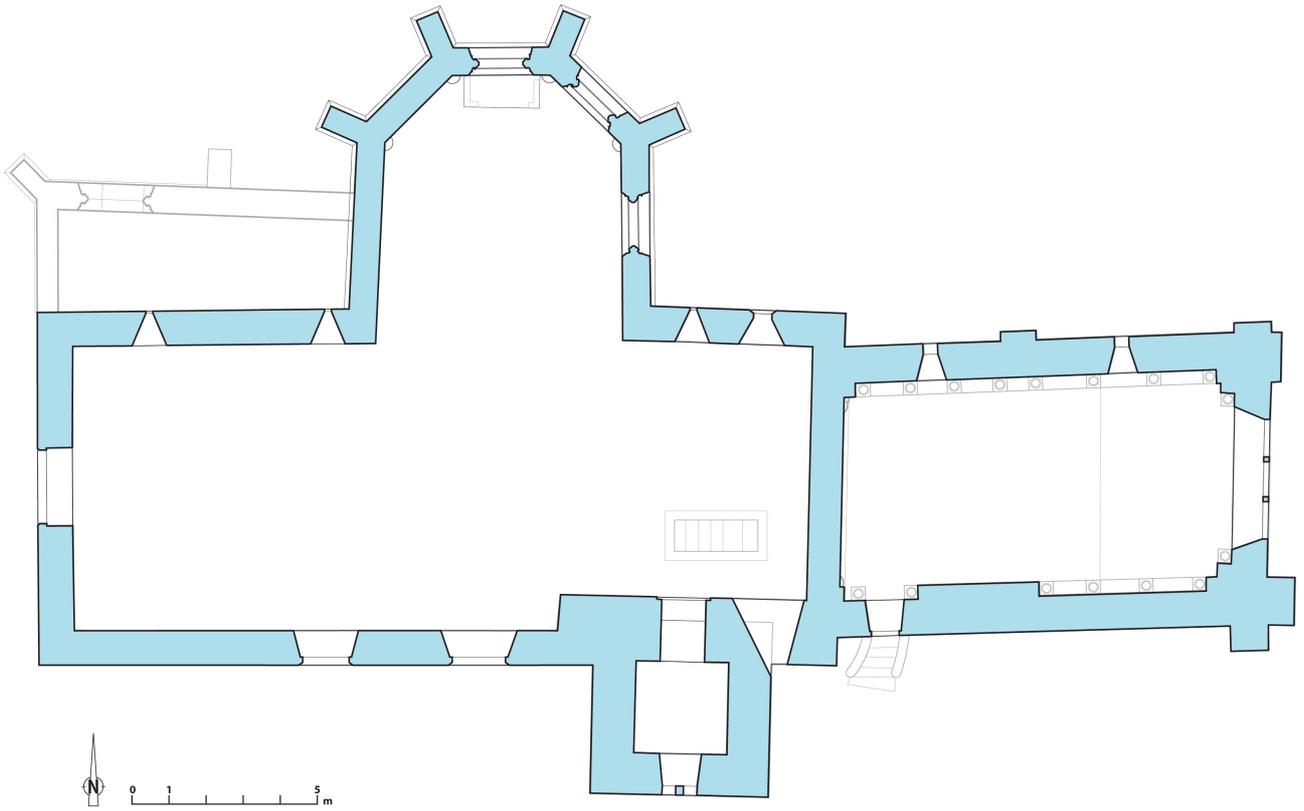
Proposition de restitution du plan de l'église après construction de la chapelle latérale (XIII^e – XIV^e siècles).
